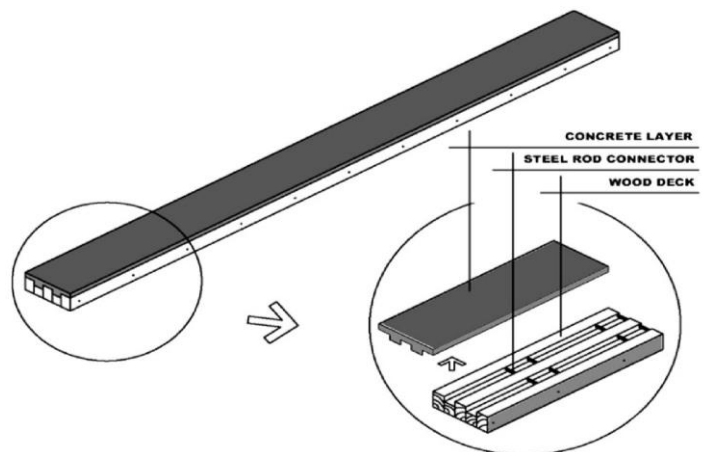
Poutre mixte Bois-Béton avec des connexions horizontales [61].
